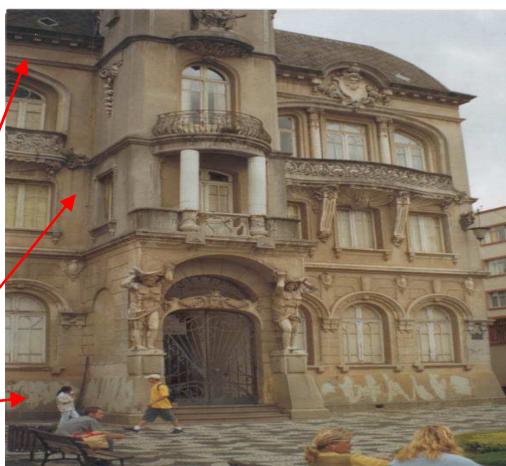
Fachada Principal – crostas negras, escoamentos superficiais e pichações.
